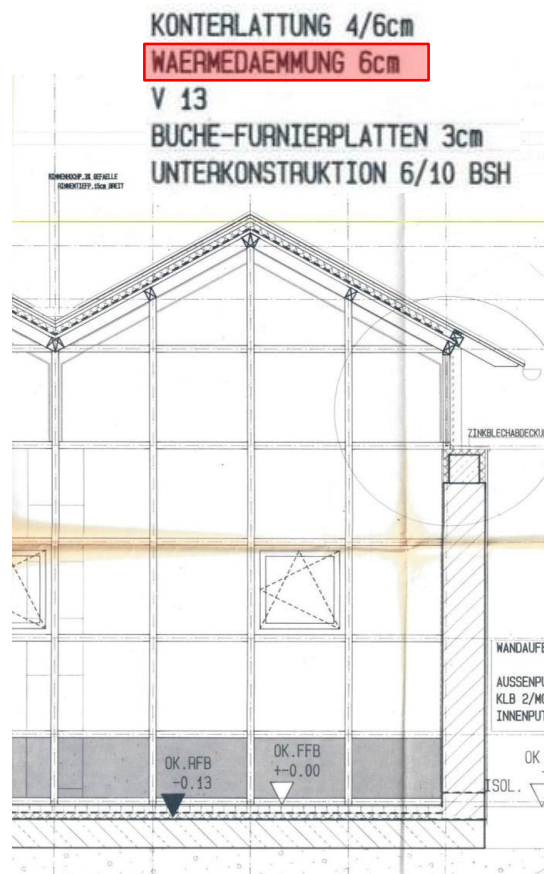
Auszug Schnitt Ausführungsplanung KiTa Schrägdachaufbau
